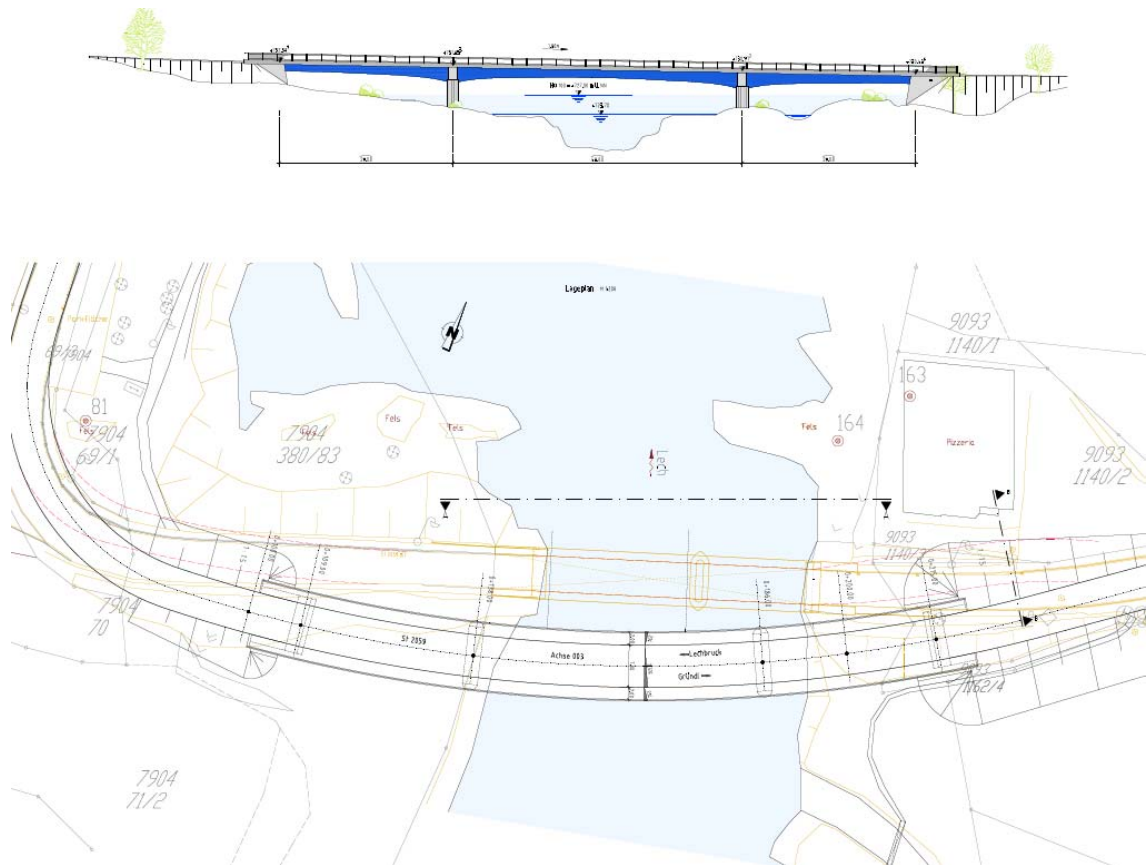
Variante 3 in Grundriss und Ansicht
